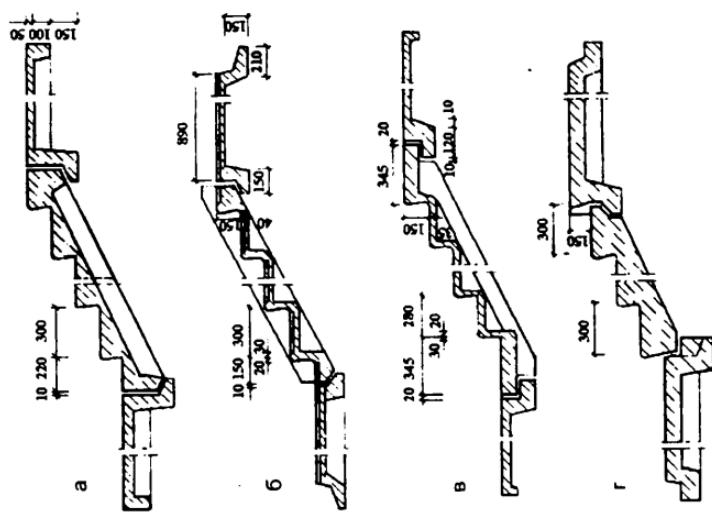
Конструктивные решения железобетонных сборных лестниц из крупных элементов:
